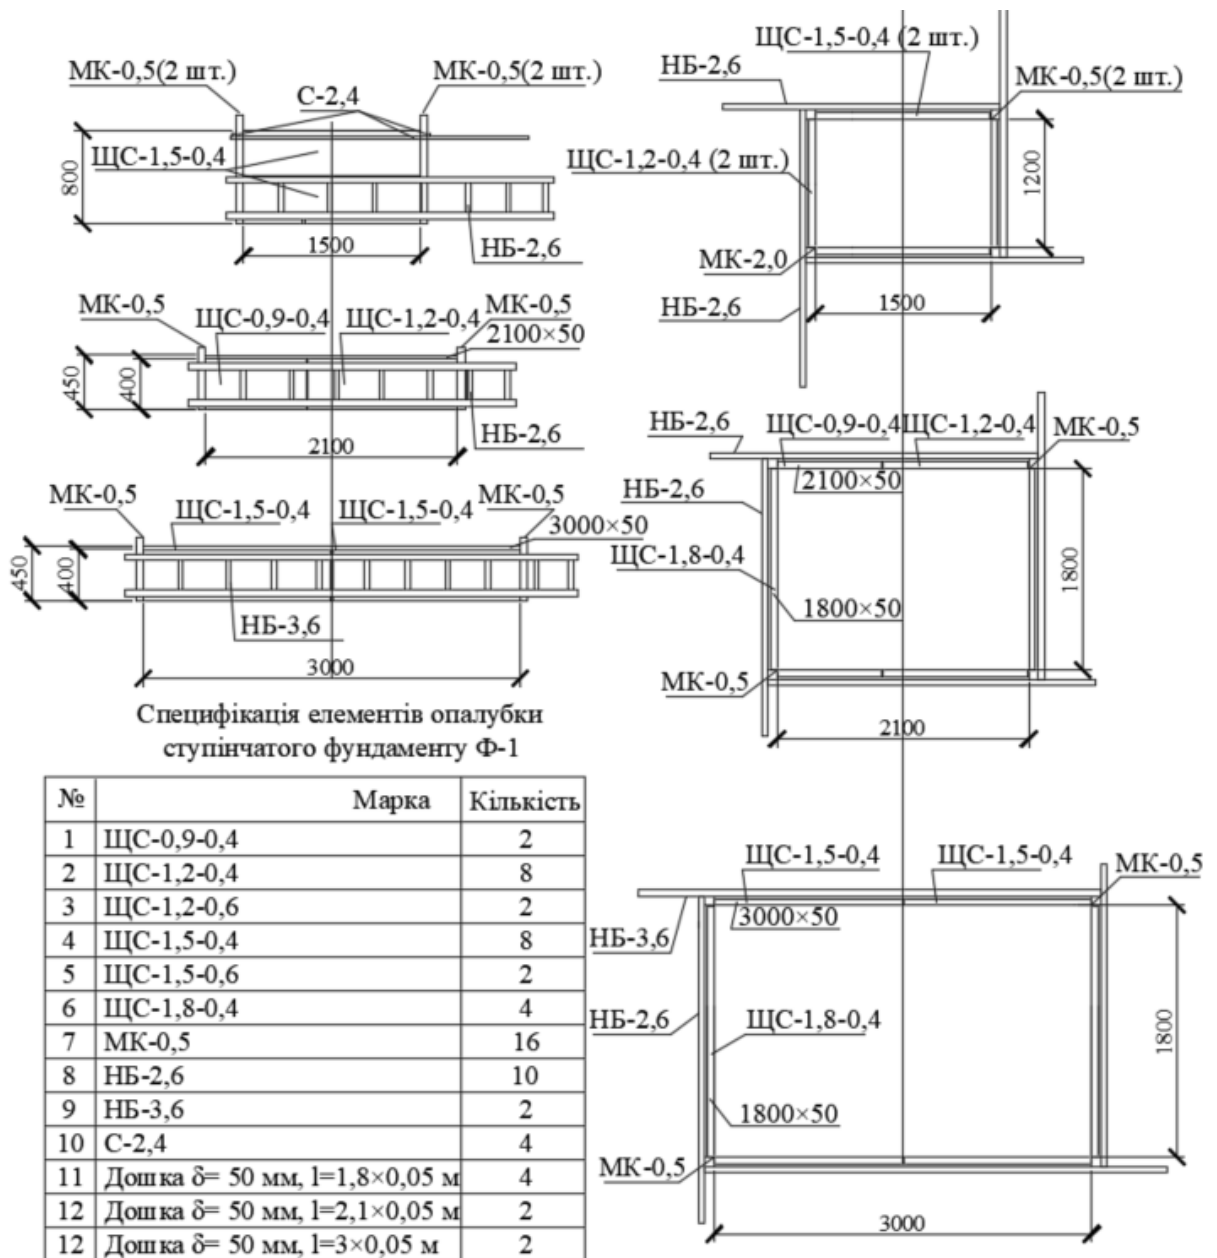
Маркувальна схема ступінчастого фундаменту зі специфікацією елементів опалубки
